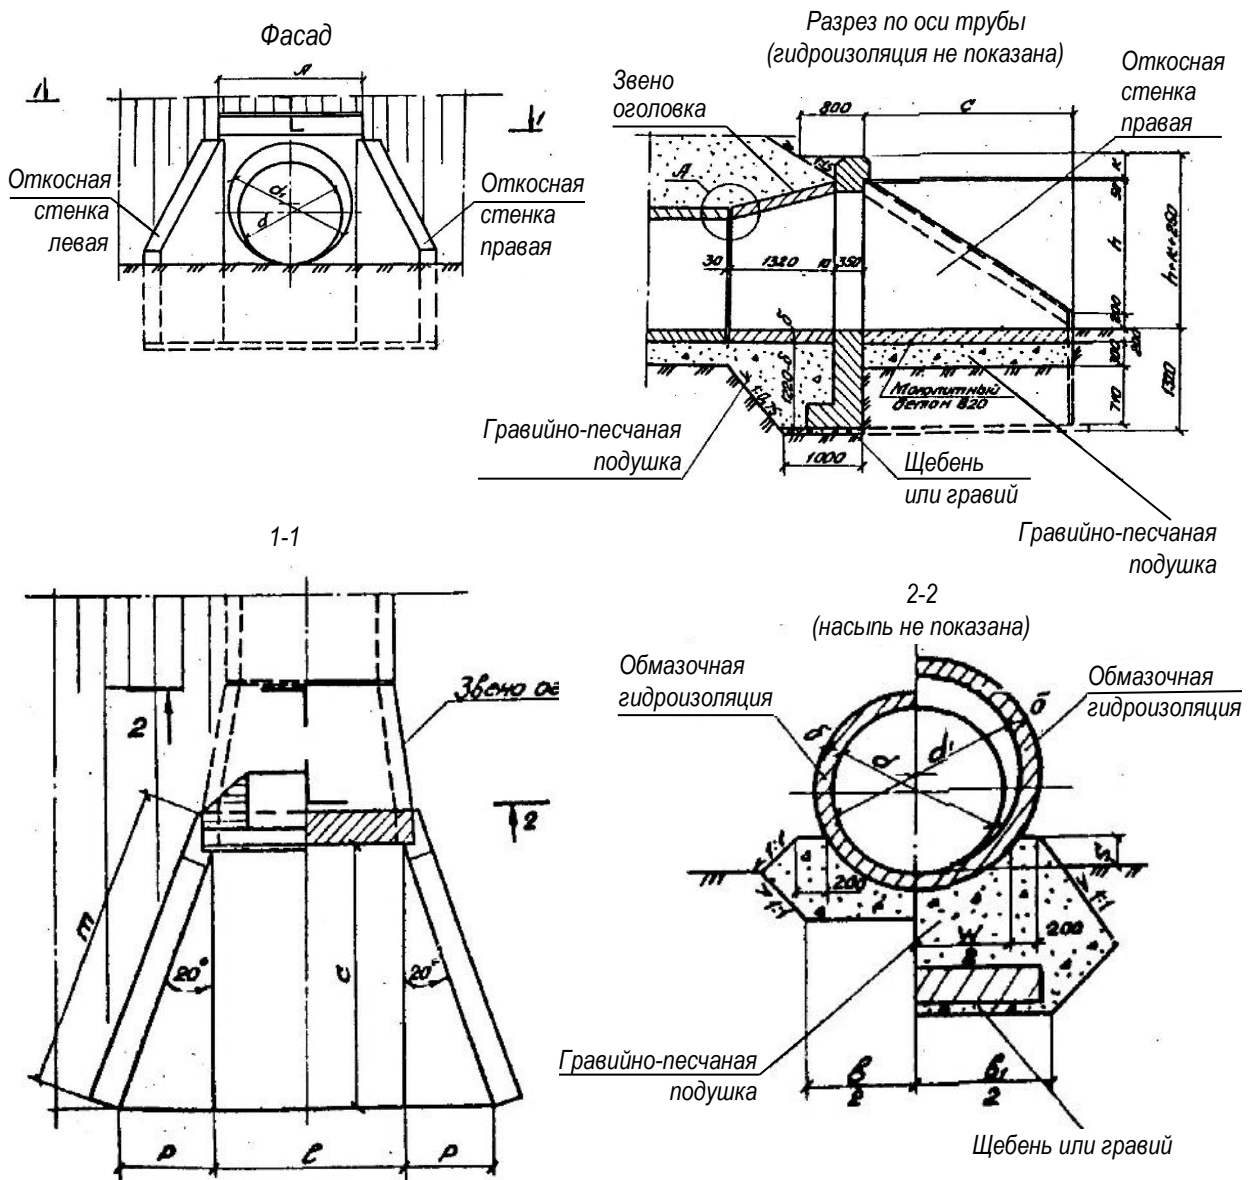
Конструкция раструбного оголовка трубы с коническим звеном
